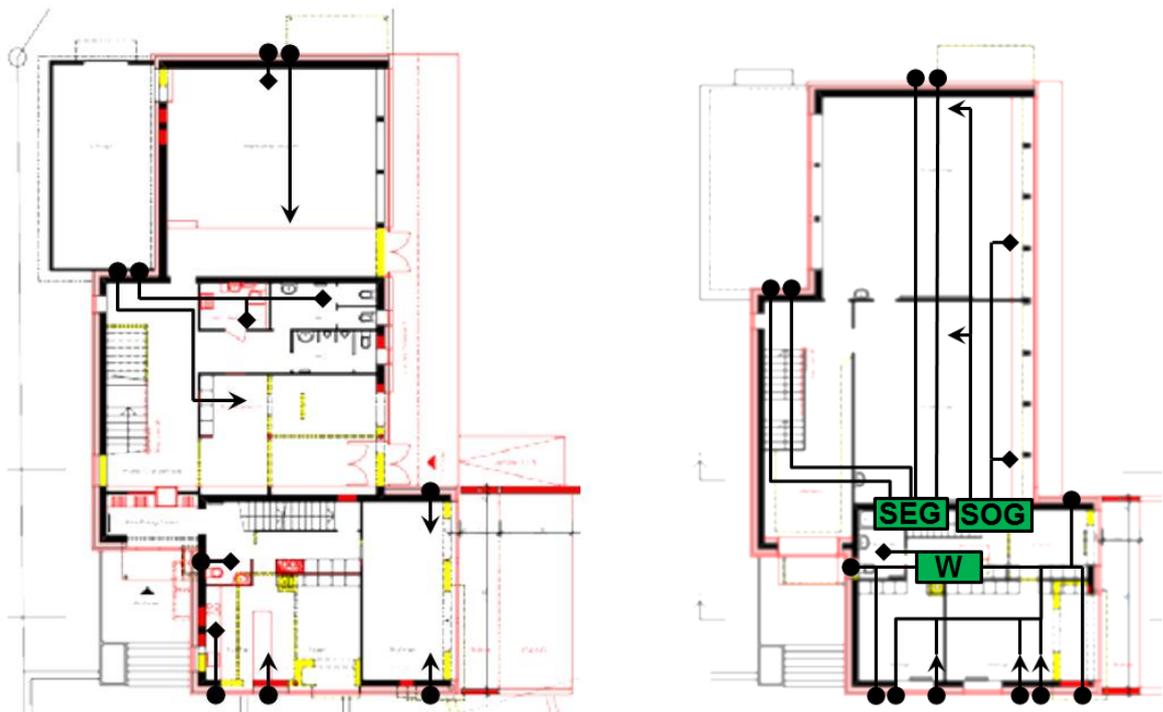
Grundrisse des Schulhauses Krummbach Erdgeschoss (links) und Obergeschoss (rechts)
